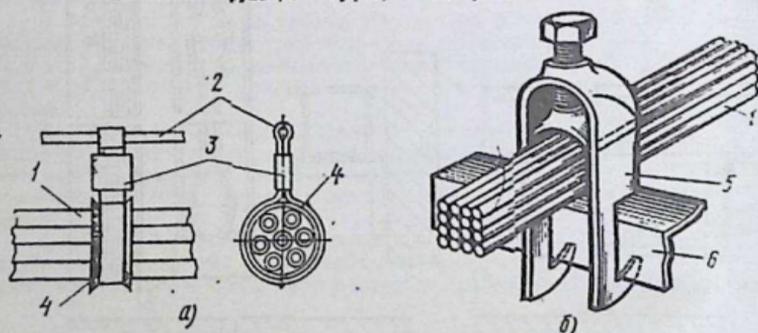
Крепление пакета пластмассовых труб с подвеской к стальной проволоке (а) и на металлических конструкциях кабельными прижимами типа ПКТ (б):
